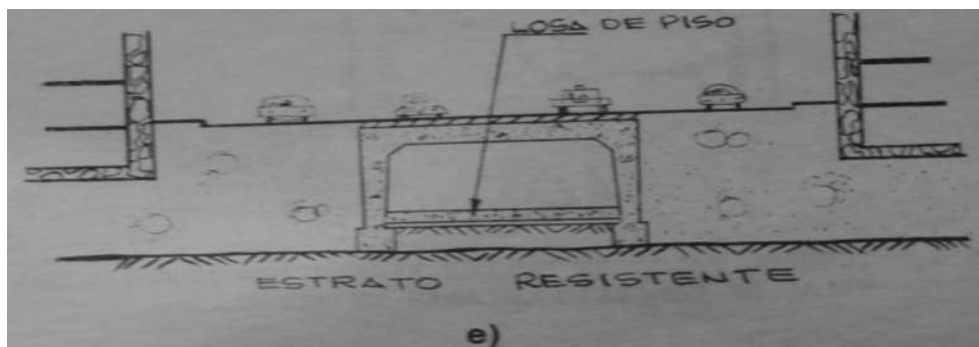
Ligue de losa de piso con muros estructurales
